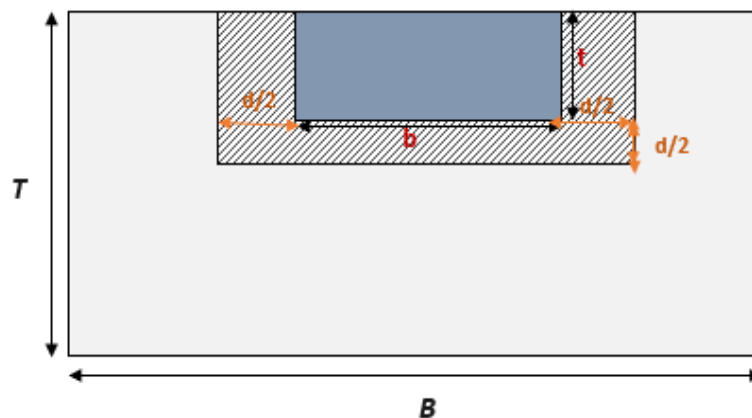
Esquema zapata, columna y zona de punzonamiento. Elaborada por la autora.
